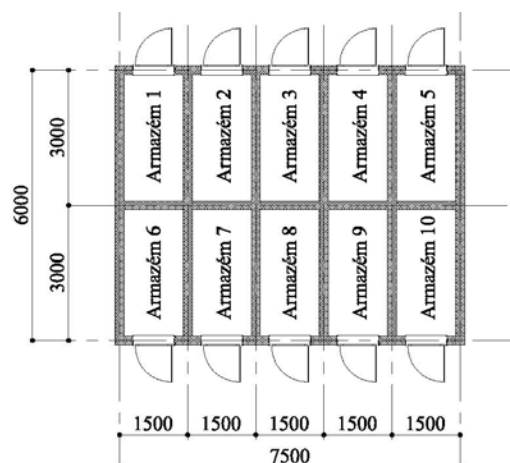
Plano Bidimensional dos Armazéns para Instrumentos de Pesca
